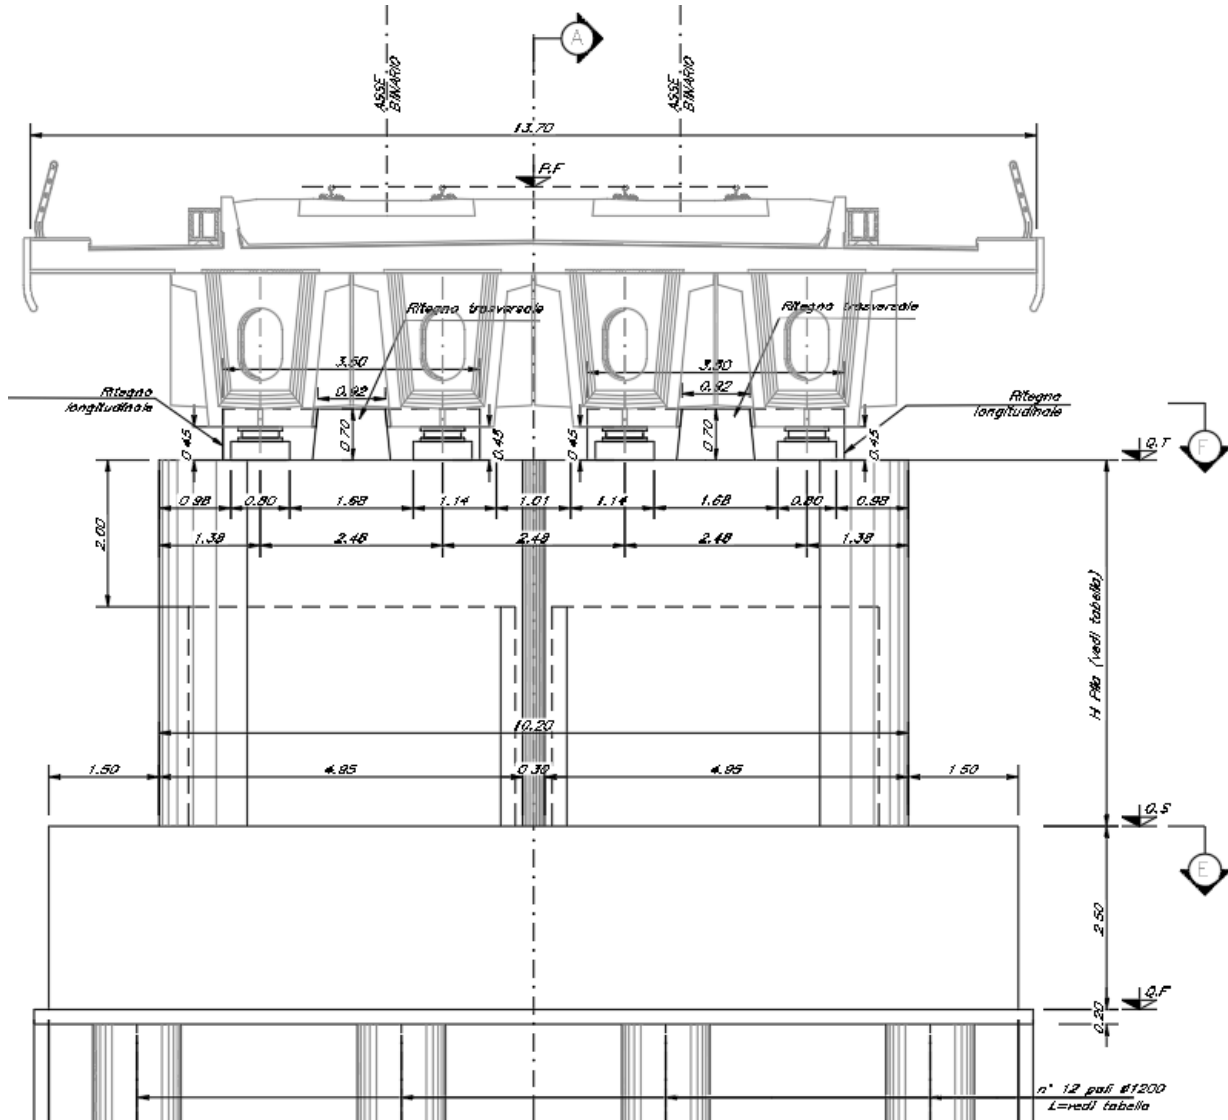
Pila scatolare doppio binario – prospetto trasversale
